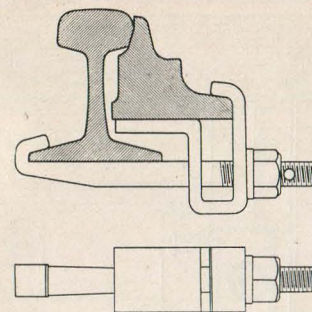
Sporskifteaflaasning med Bolt og Hængelaas, nyere Form.
